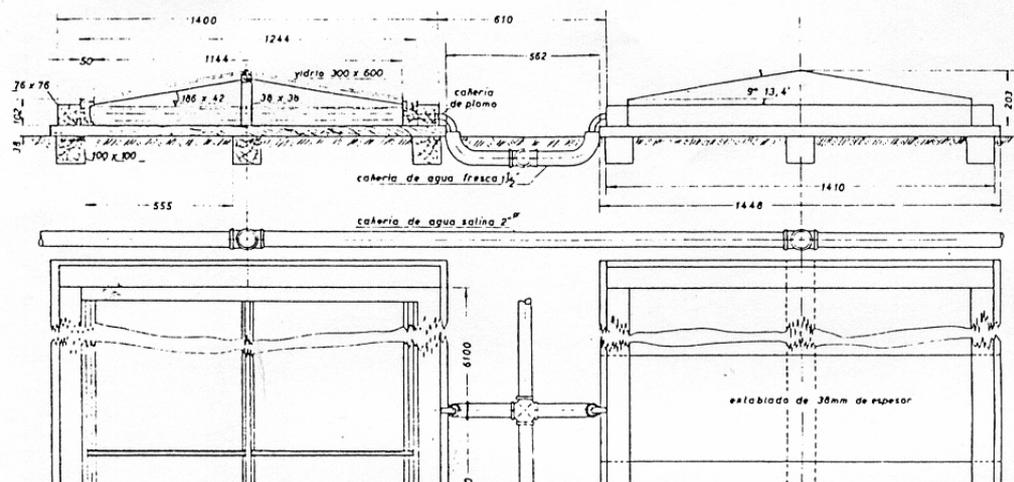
DETALLE DESTILADOR SOLAR EN LAS SALINAS DISEÑADO POR CARLOS WILSON.
